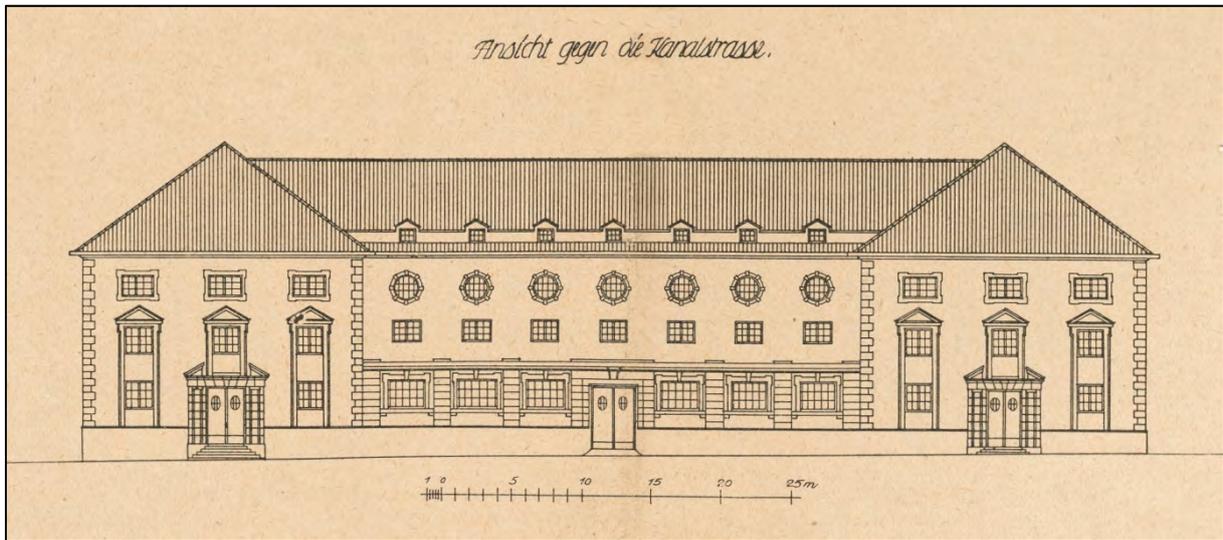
Bauplan der Maschinenbauschule – Hauptansicht (nicht ausgeführte Variante)
